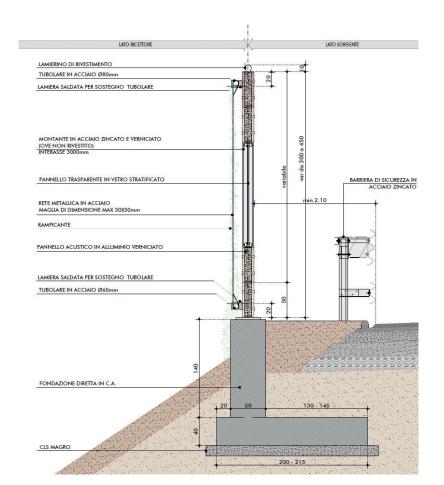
SEZIONE TIPOLOGICA DELLA BARRIERA ACUSTICA MISTA FONOASSORBENTE-FONOISOLANTE SU RILEVATO
